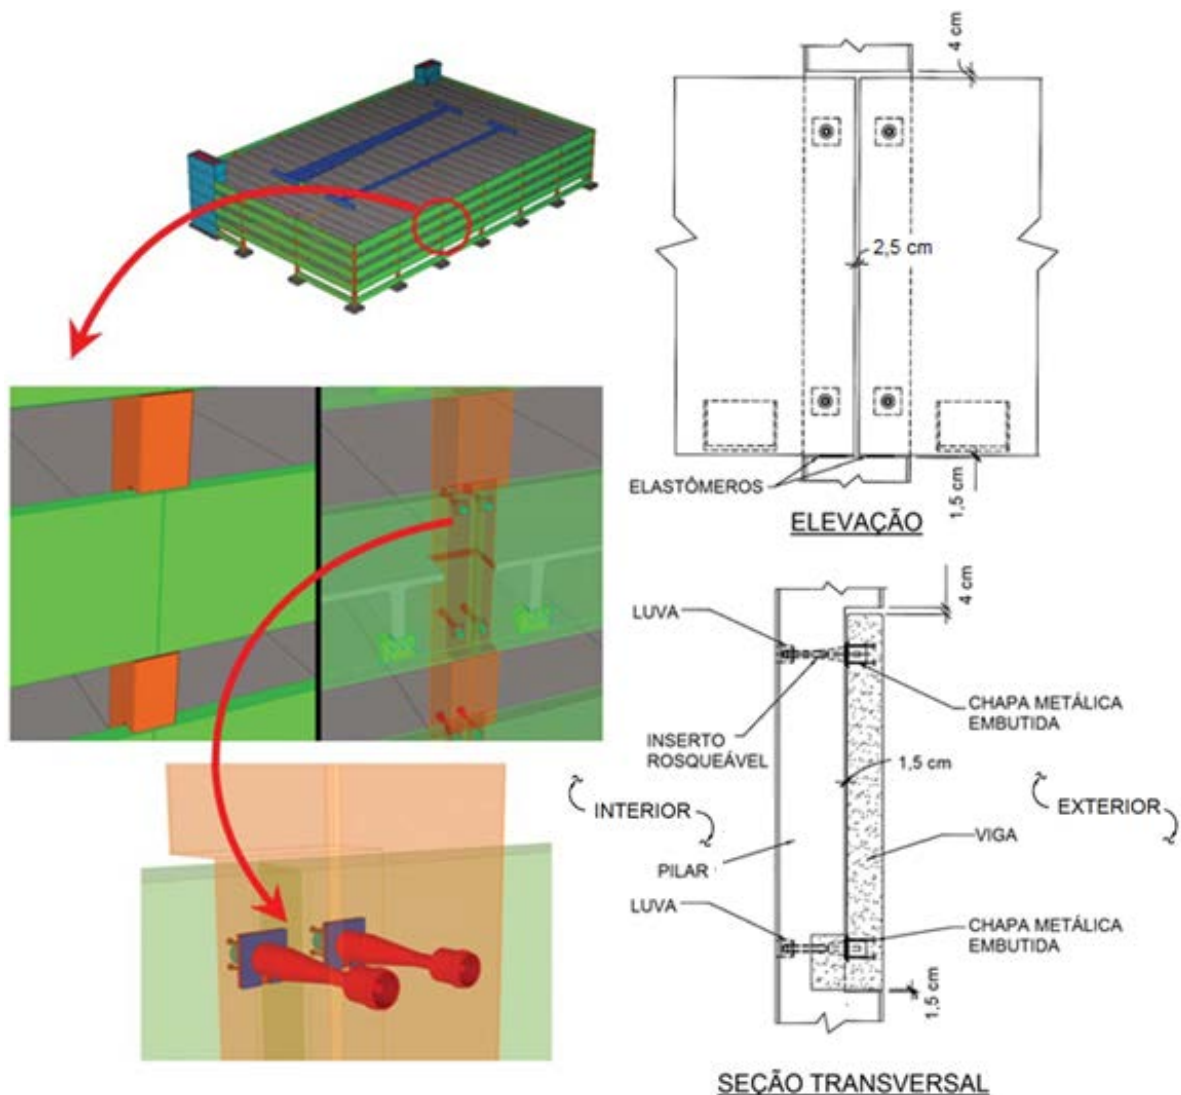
Ligação viga-pilar típica para vigas com peitoril alto e delgado sujeitas à torção no apoio, opção com pilar posicionado para dentro do edifício [SHOCKEY, 2008].
